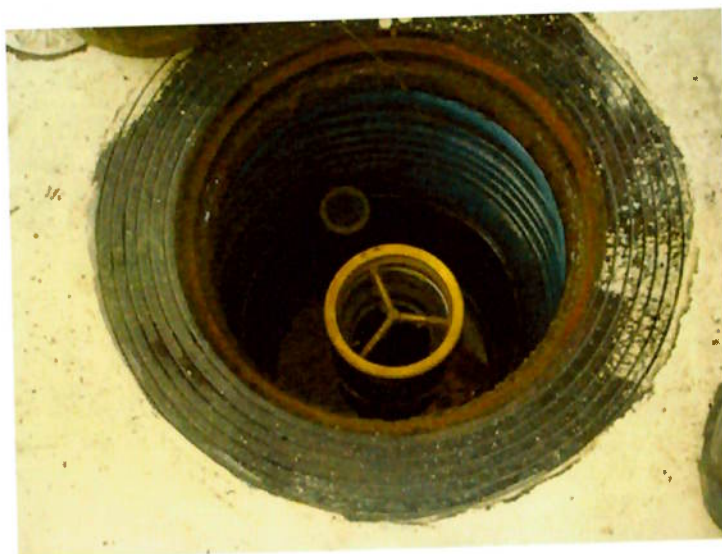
Bocal de carregamento com dispositivo para descarga selada
